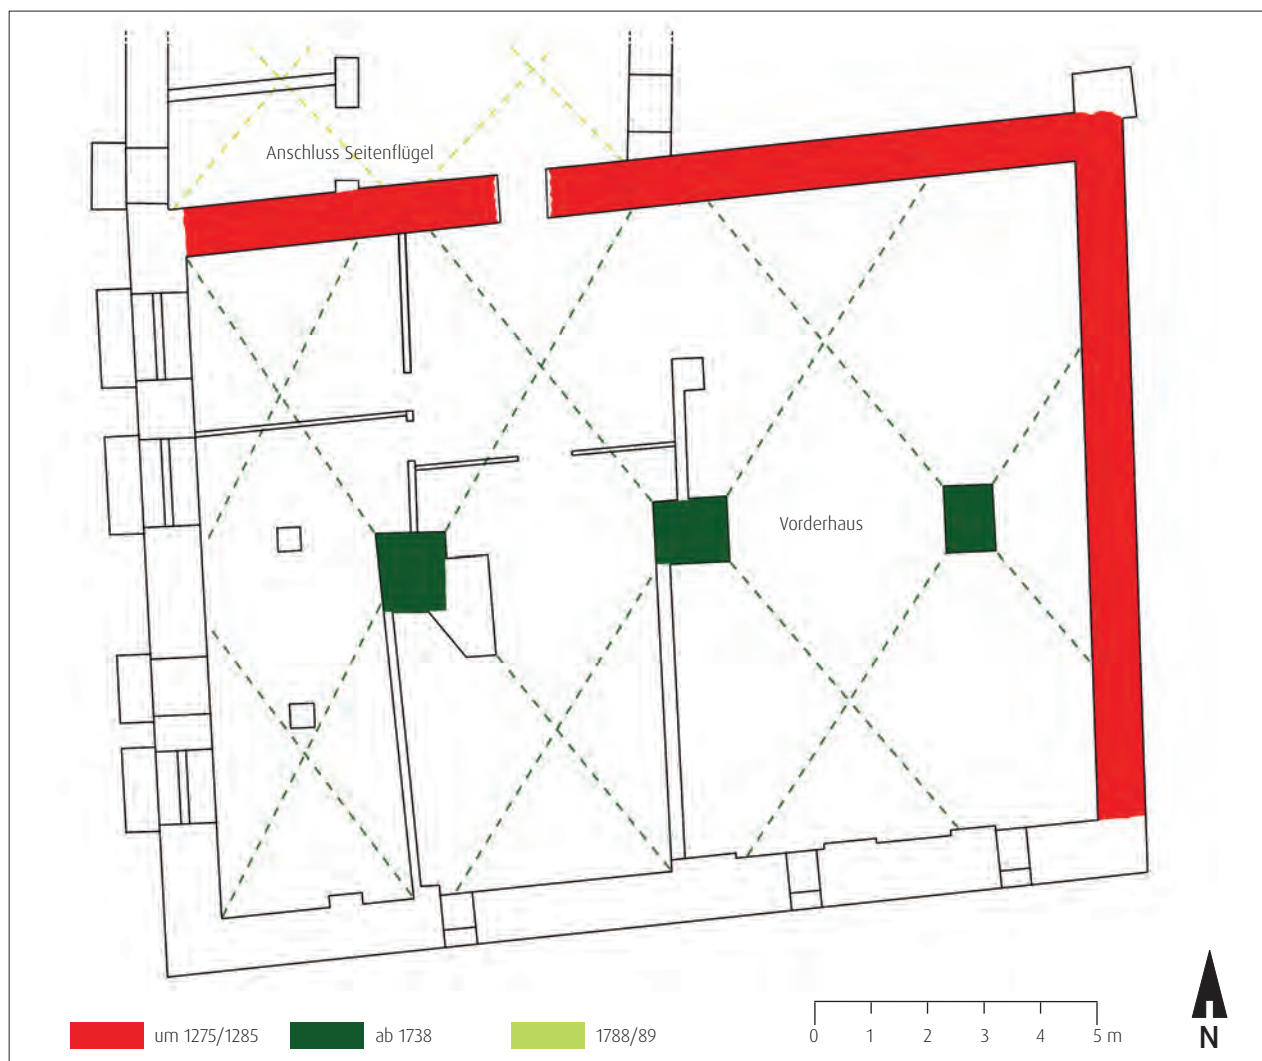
Greifswald, Lange Straße 82. Kellergeschoss des Haupthauses. Grundriss mit Kartierung der wichtigsten Bauphasen. Zeichnung: D. Brandt / A. Lutze (2016). Plangrundlage: Planungsgesellschaft für Haus und Stadterneuerung mbH (PHS) Greifswald (2008)
